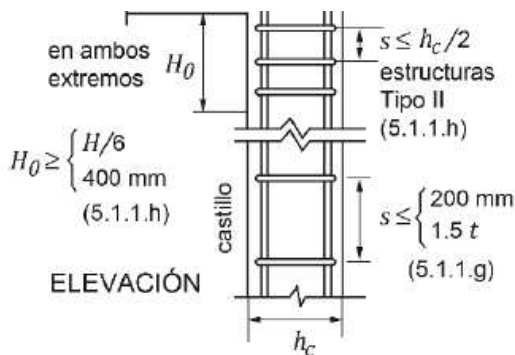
Espaciamiento mínimo del refuerzo transversal, columna de confinamiento.
